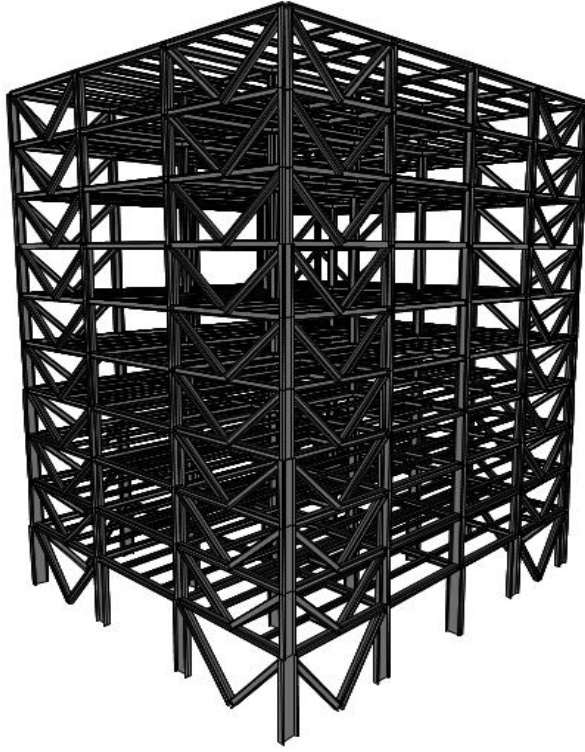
MÇÇ Sistemlerin Yapı Planı
